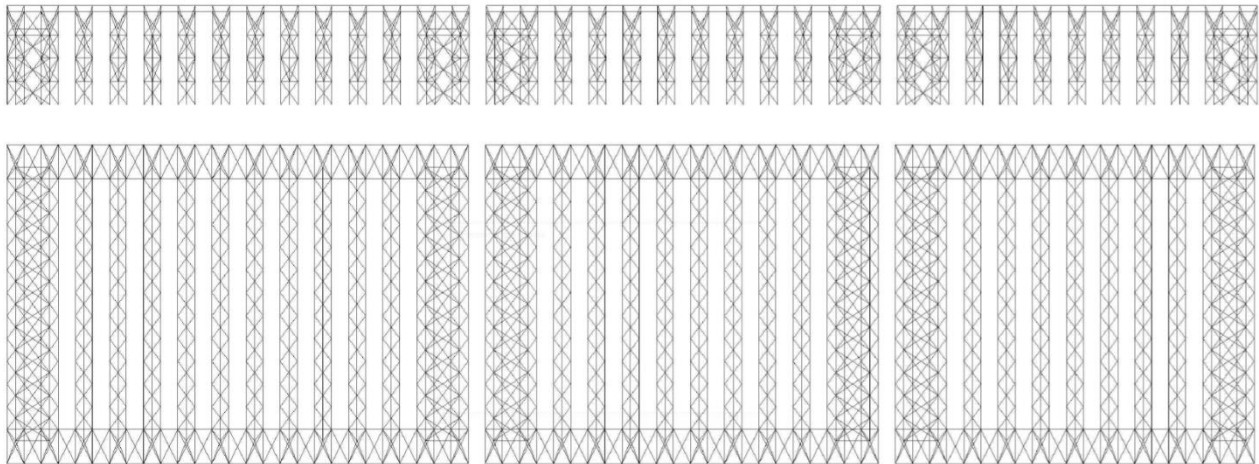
ALZADO LONGITUDINAL Y PLANTA DE LA ESTRUCTURA DEL SAINSBURY CENTRE
